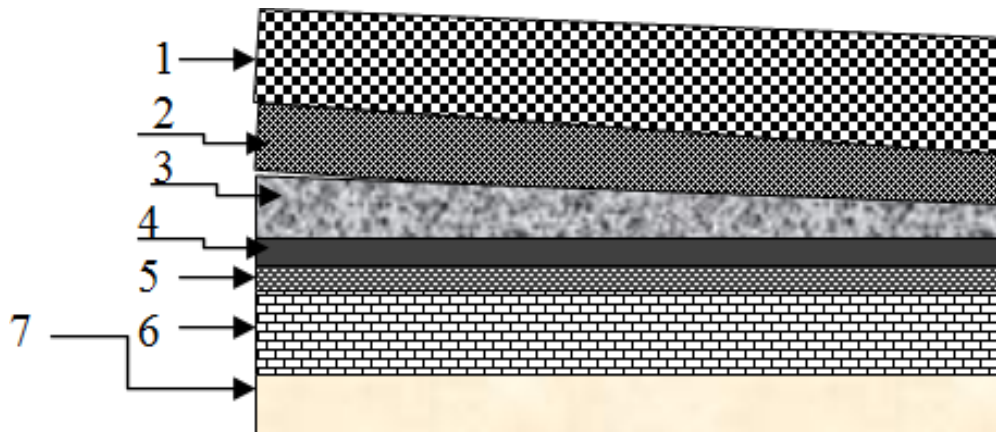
Coupe verticale d'un plancher terrasse inaccessible
